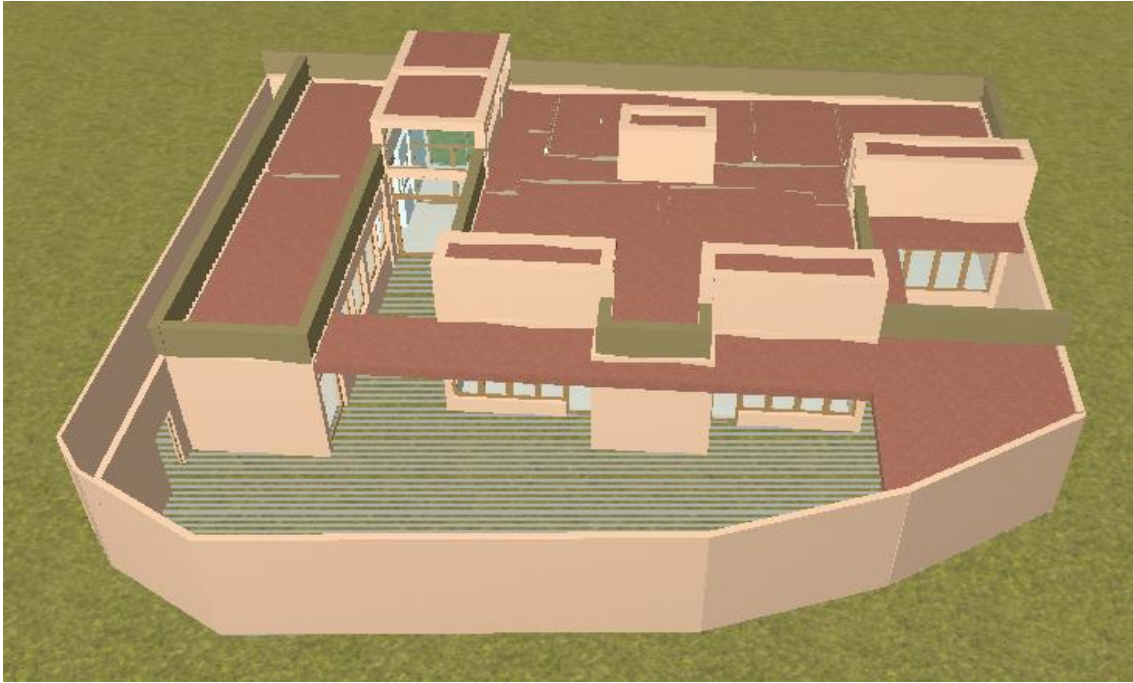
Levantamiento 3D Edificio. Fuente: Programa CypeMEP
